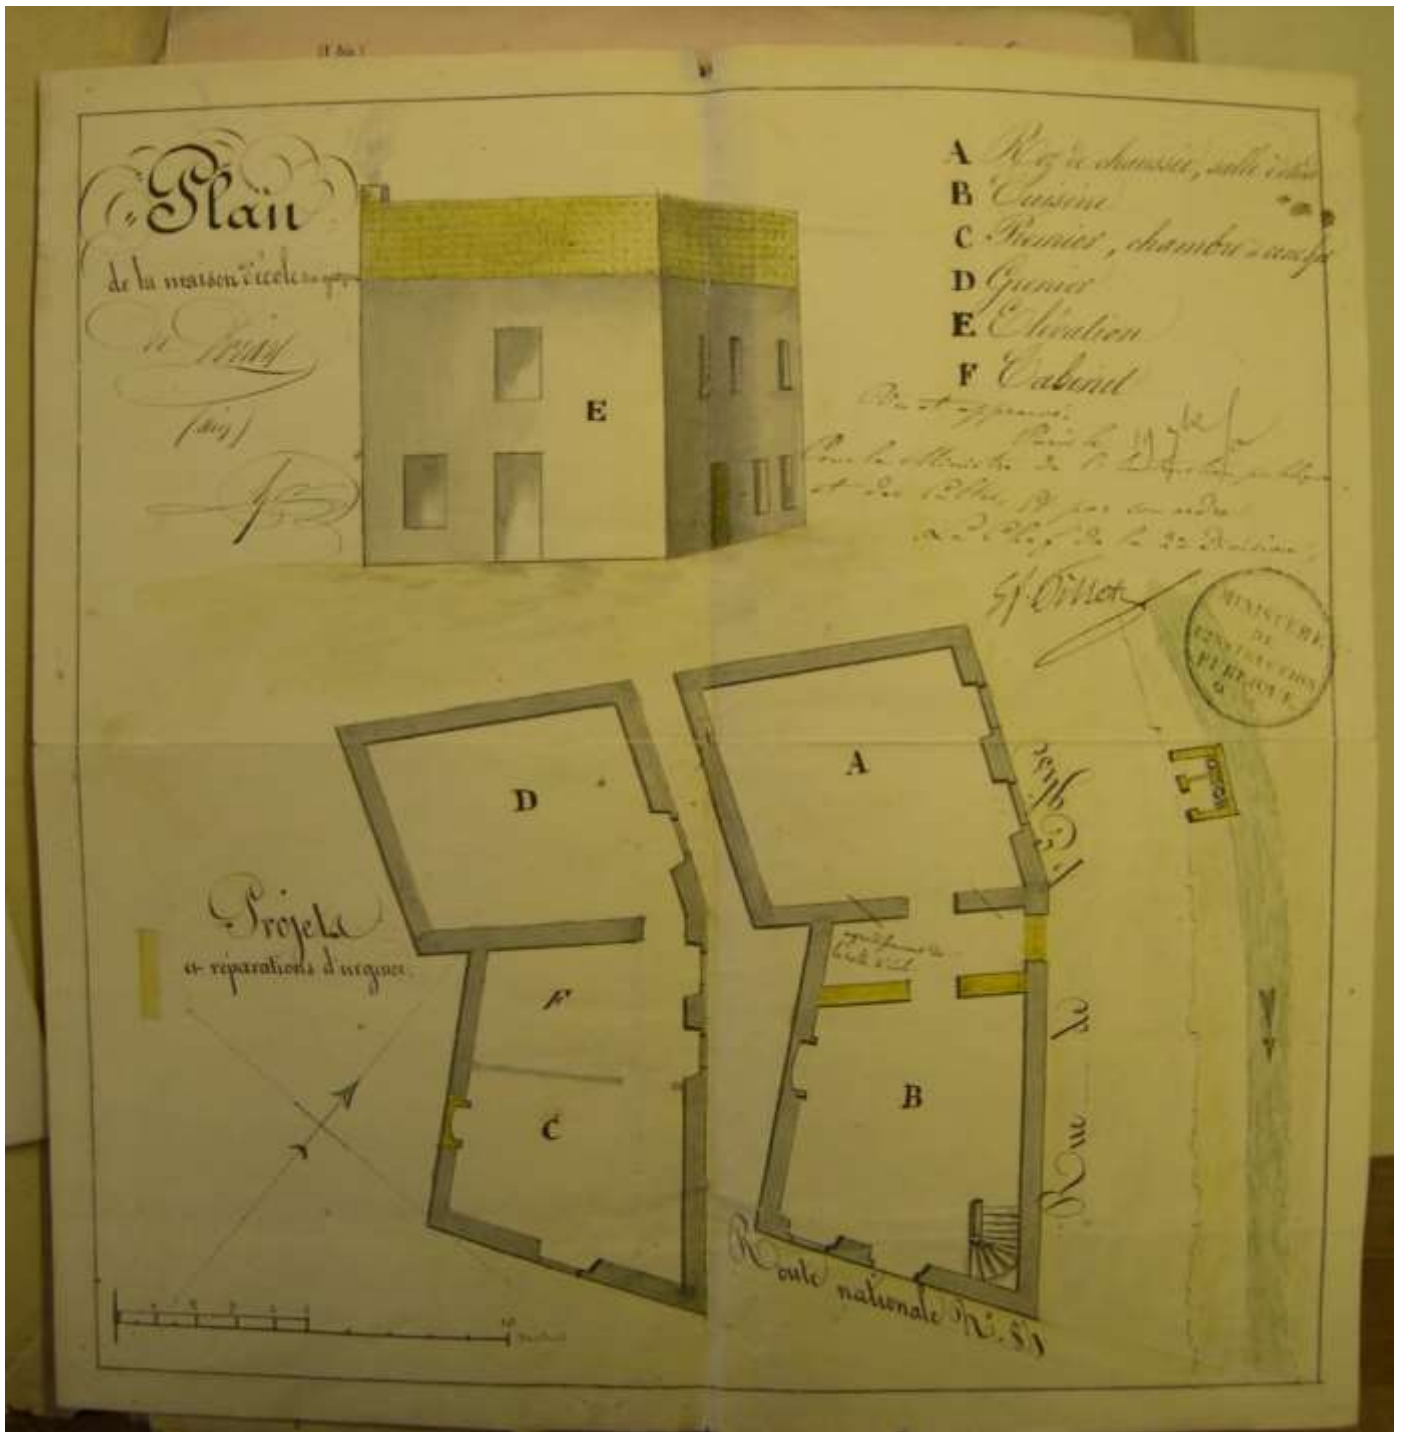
Ecole mixte des Carronnières : construction (1881)
